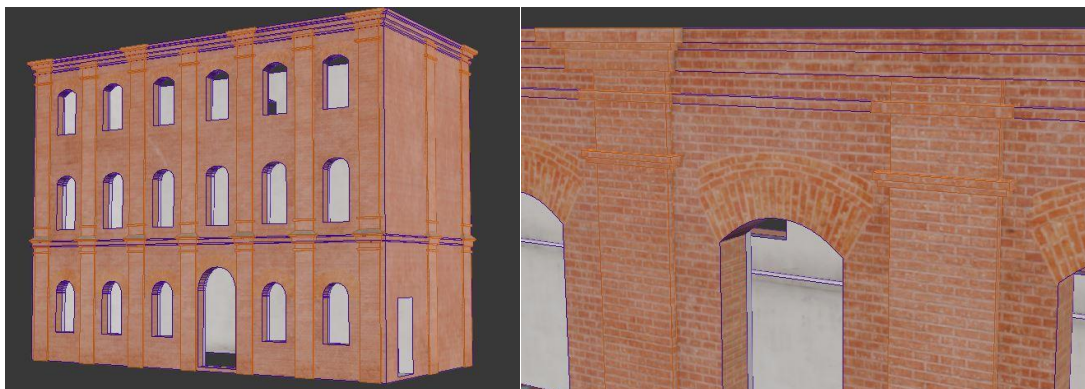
Vista general de la fachada con las columnas texturizadas (izq.). Detalle del tramo superior de las columnas (dcha.).
